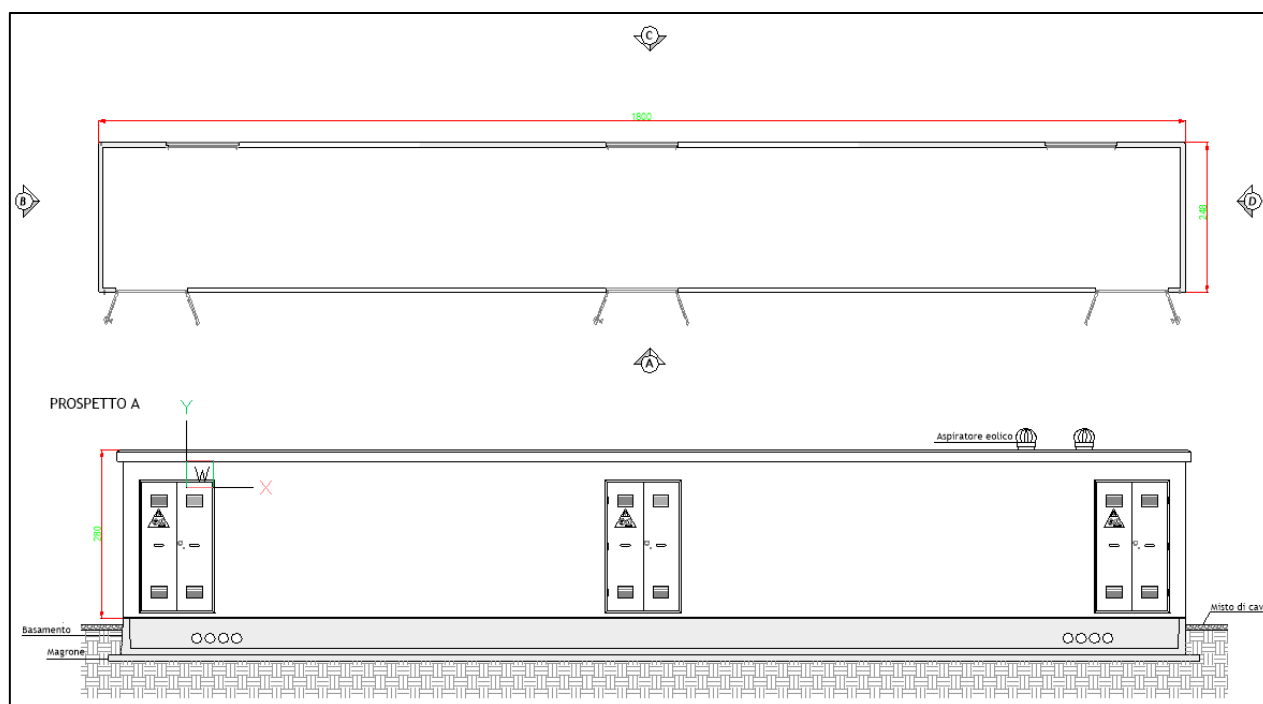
Planimetria e prospetto della Cabina di Raccolta R1
